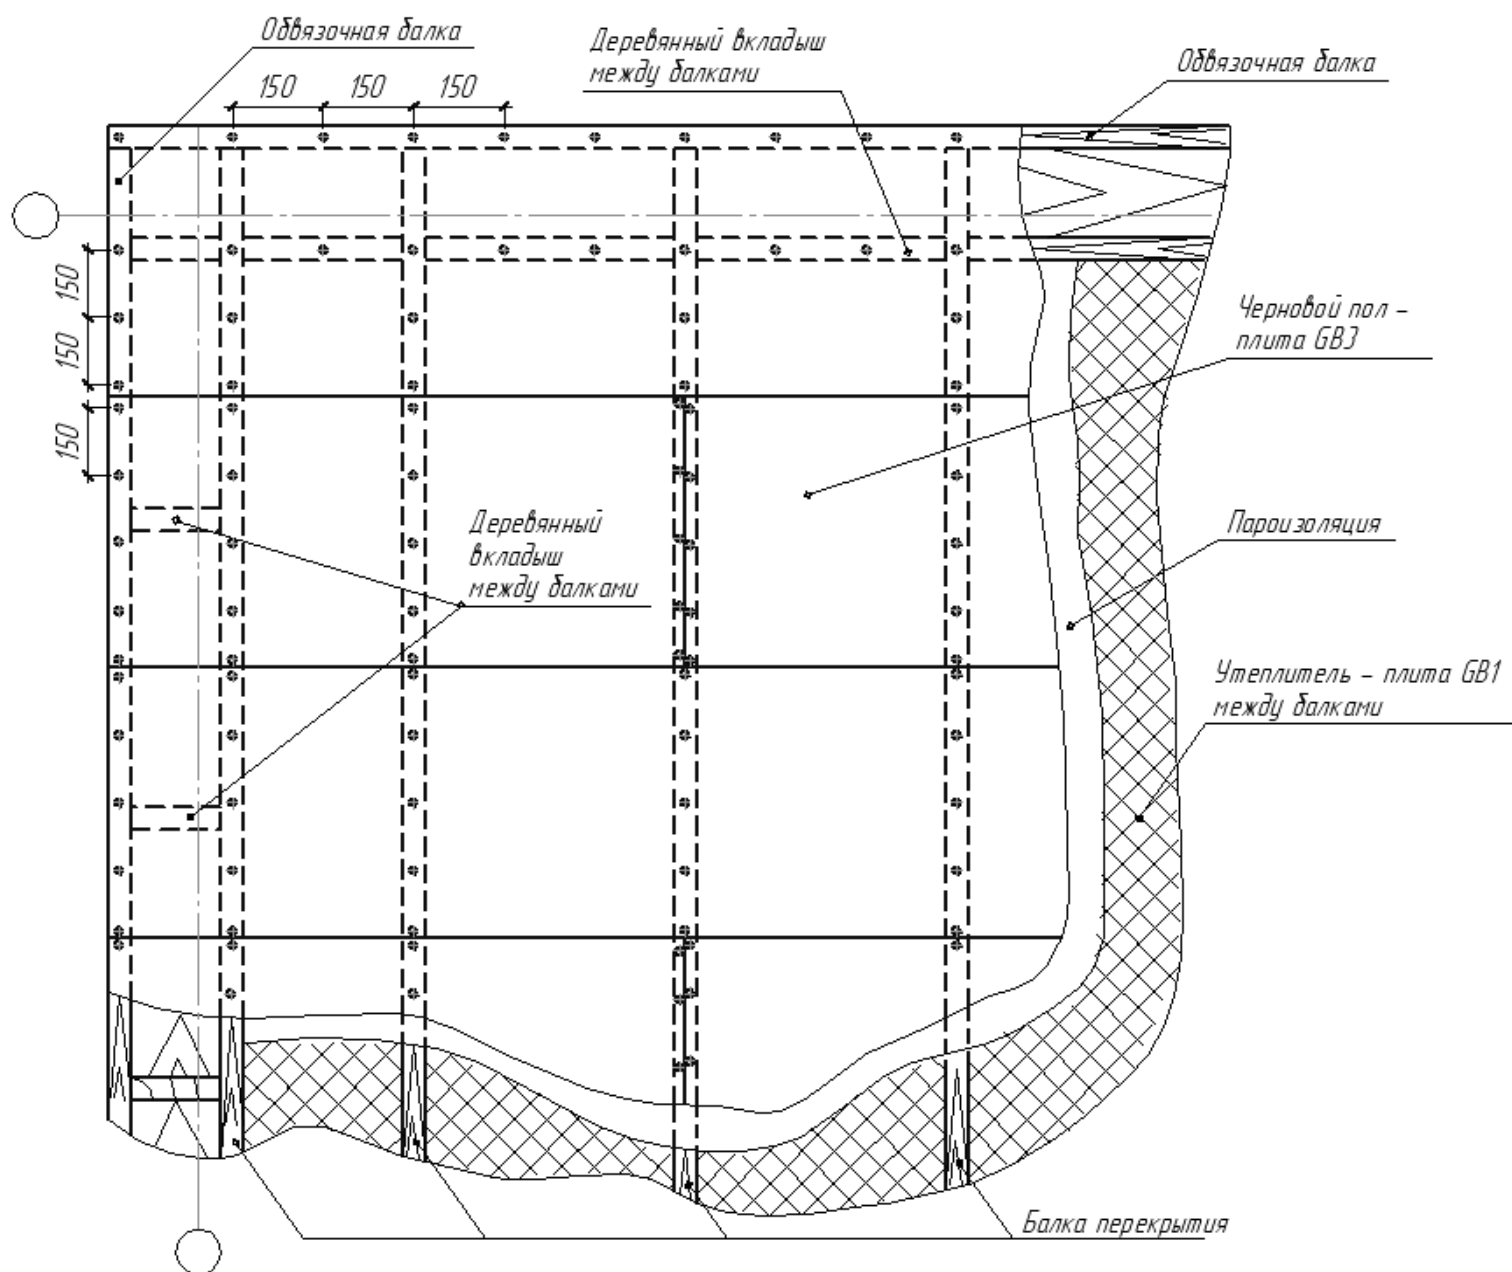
Крепление чернового пола - плит ГВЗ - к балкам перекрытия
